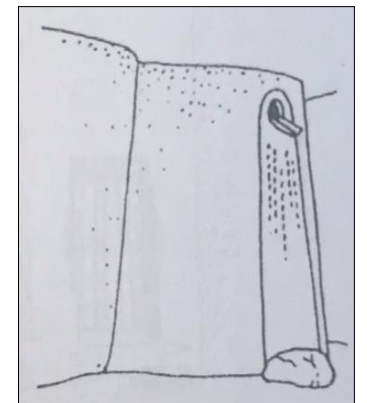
Exemple de gargouille possédant une protection du soubassement à la base du mur.
